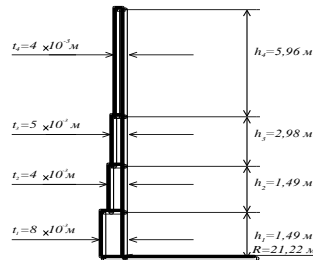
Поперечное сечение вертикального цилиндрического резервуара
